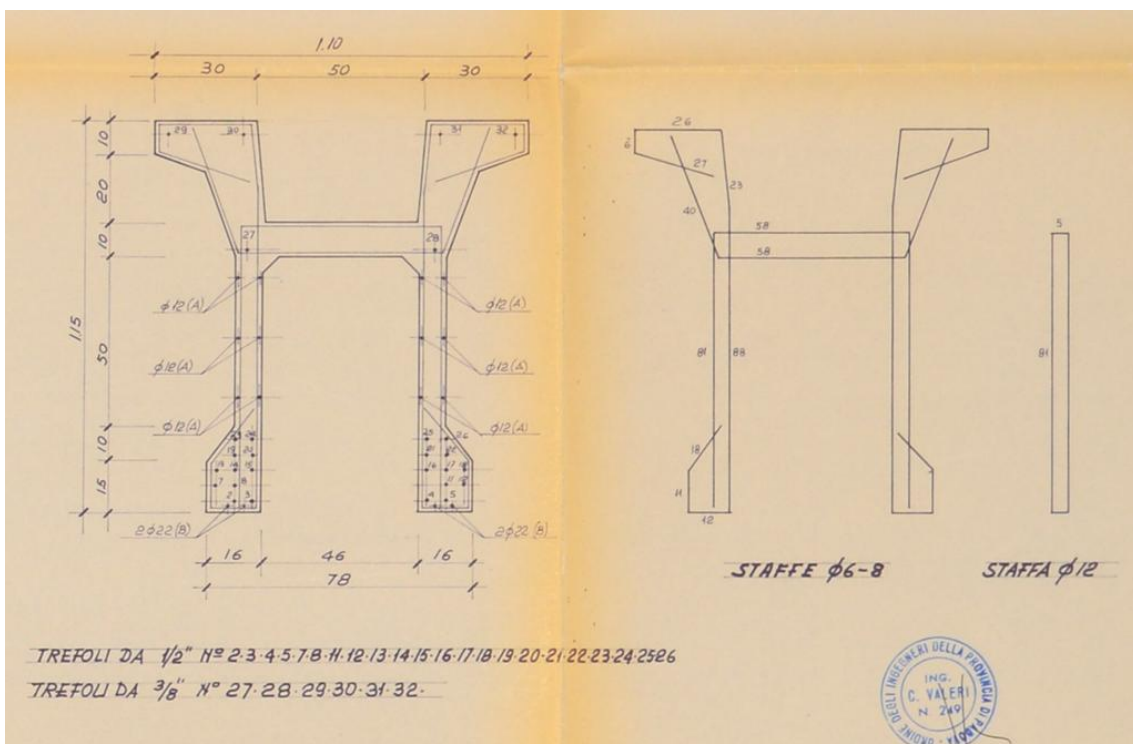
Particolare di A.1980.cap.us.T04 - Dettagli armature travi - Sezione trasversale
